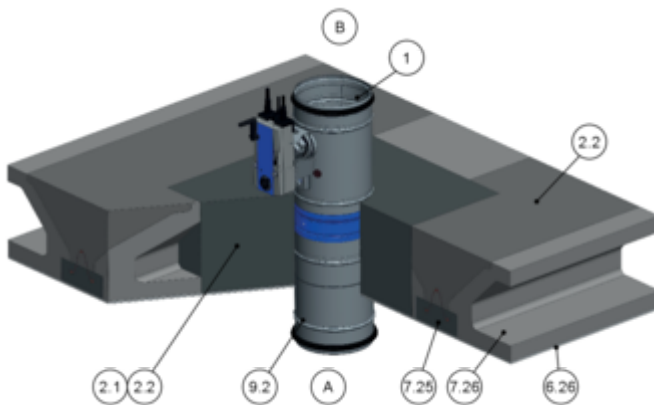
Монтаж със строителен разтвор с бетонна основа в масивна таванна плоча, изправена, многократен монтаж
